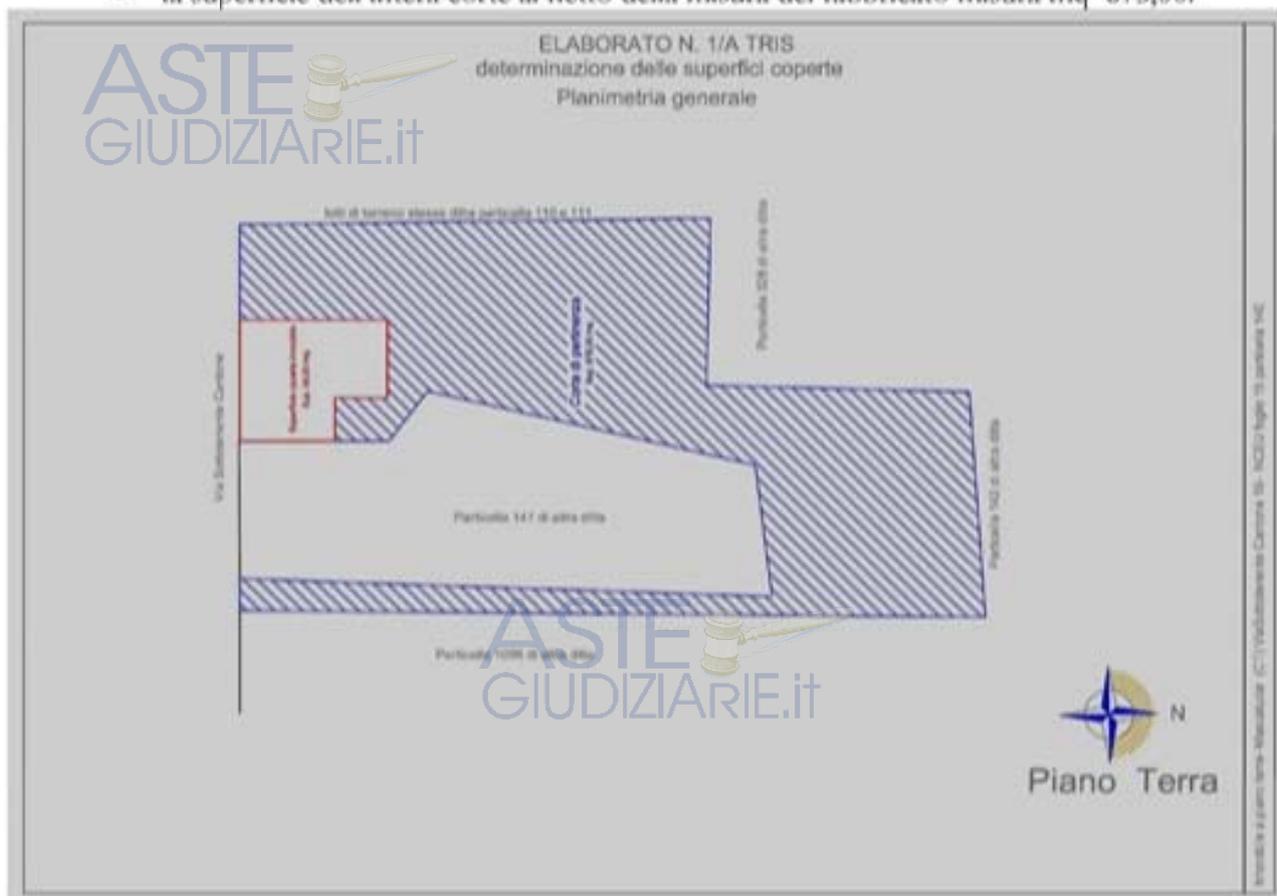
Visualizzazione della planimetria dell'immobile a piano terra riportante le superfici coperte
